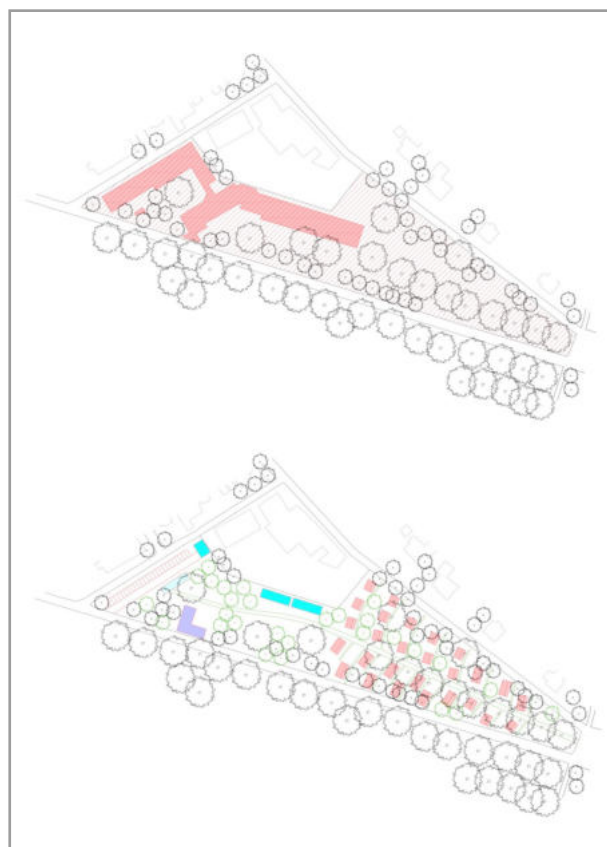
Planimetrie dello stato di fatto ed ipotesi di progetto della Colonia Marina I.P.D.A.P. del Lido di Venezia
